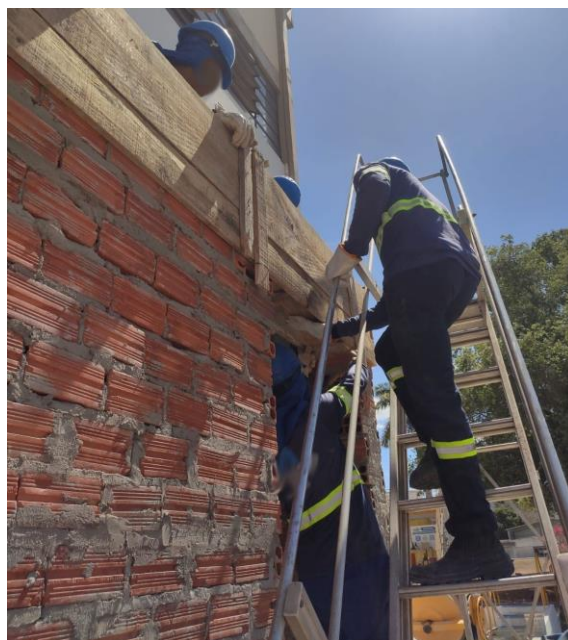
Armadura da viga posicionada de acordo projeto estrutural
